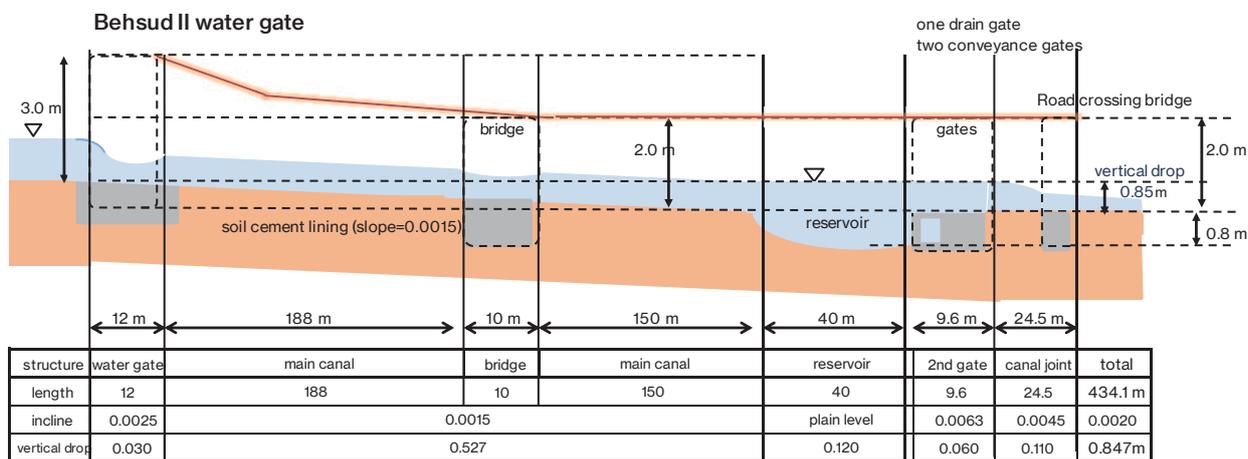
急勾配主幹用水路の縦断面図の例<sup>1)</sup>
